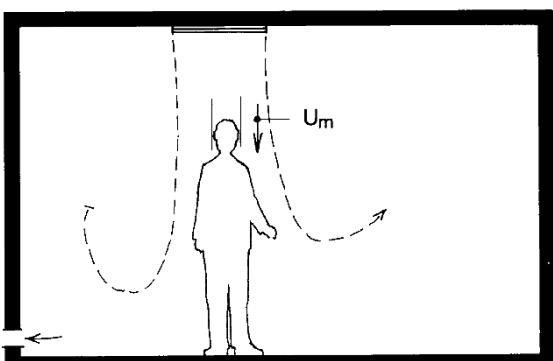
Soufflage par de grandes zones du plafond. Evacuation au niveau du sol.
